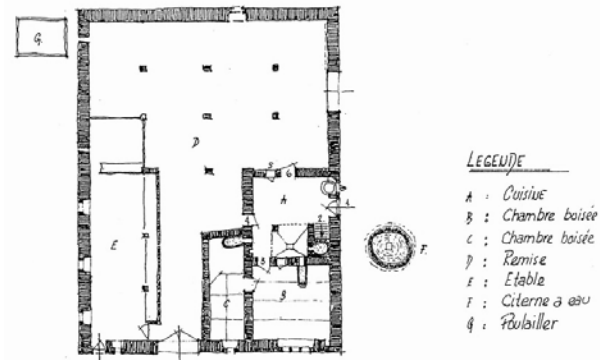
Plan d'une ferme à pignon frontal à Labran sur la commune de Chézard-Saint-Martin. Le logis occupe la partie nord-est du bâtiment. . (La direction du nord suit la diagonale du plan en direction du coin supérieur droit).
